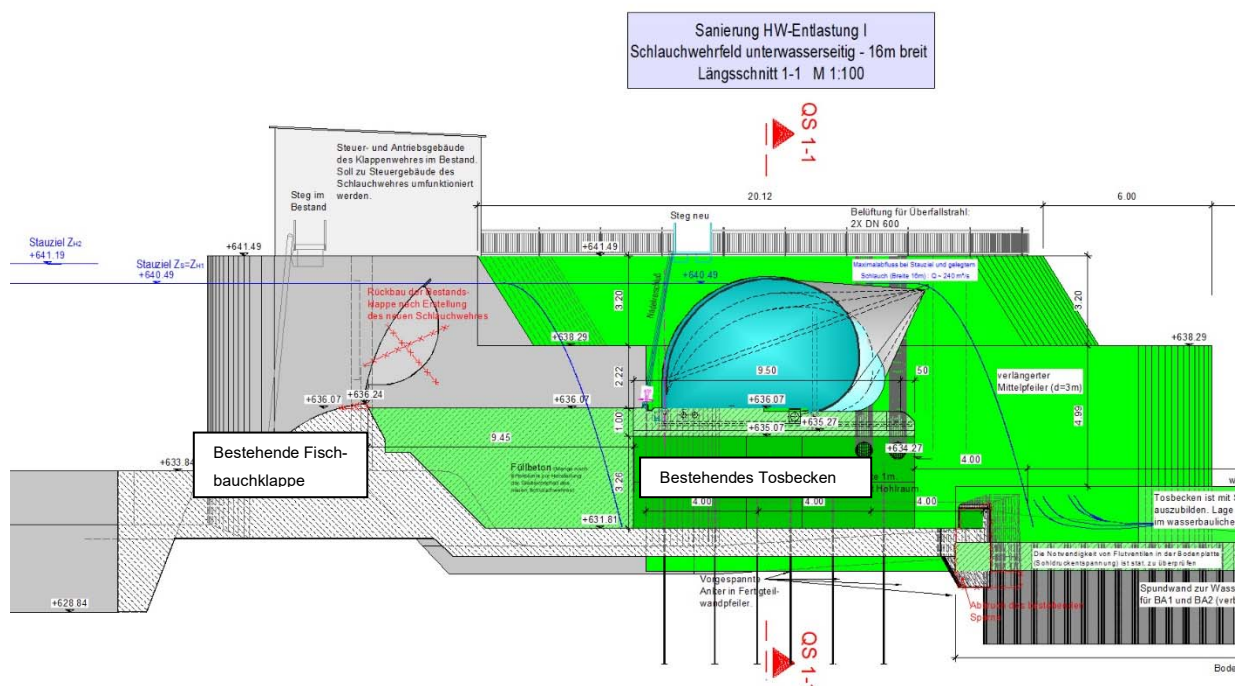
Längsschnitt – Lage des neues Schlauchwehrest
